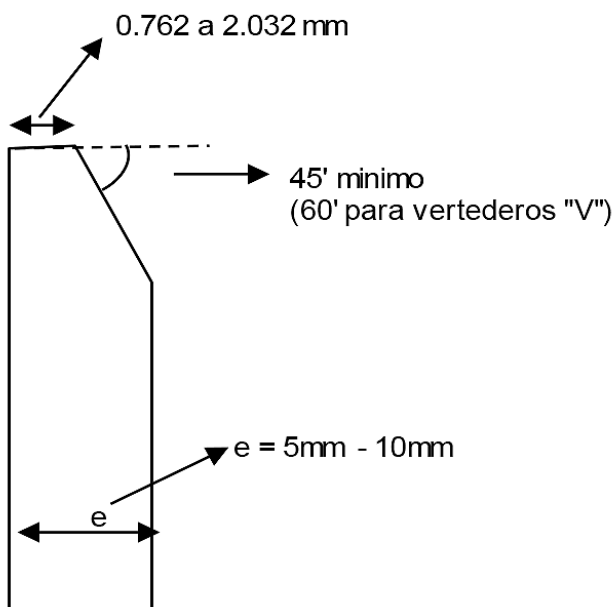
Detalles del espesor de la cresta de un vertedero (cortes longitudinal)
